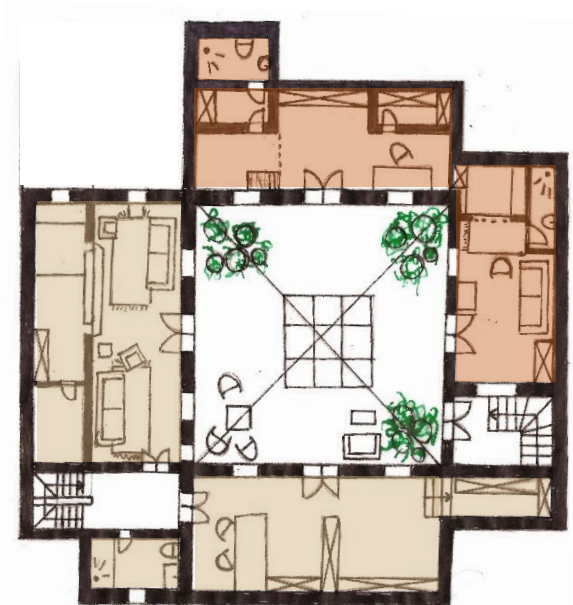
Croquis du plan du rez-de-chaussée composé de deux "L"
